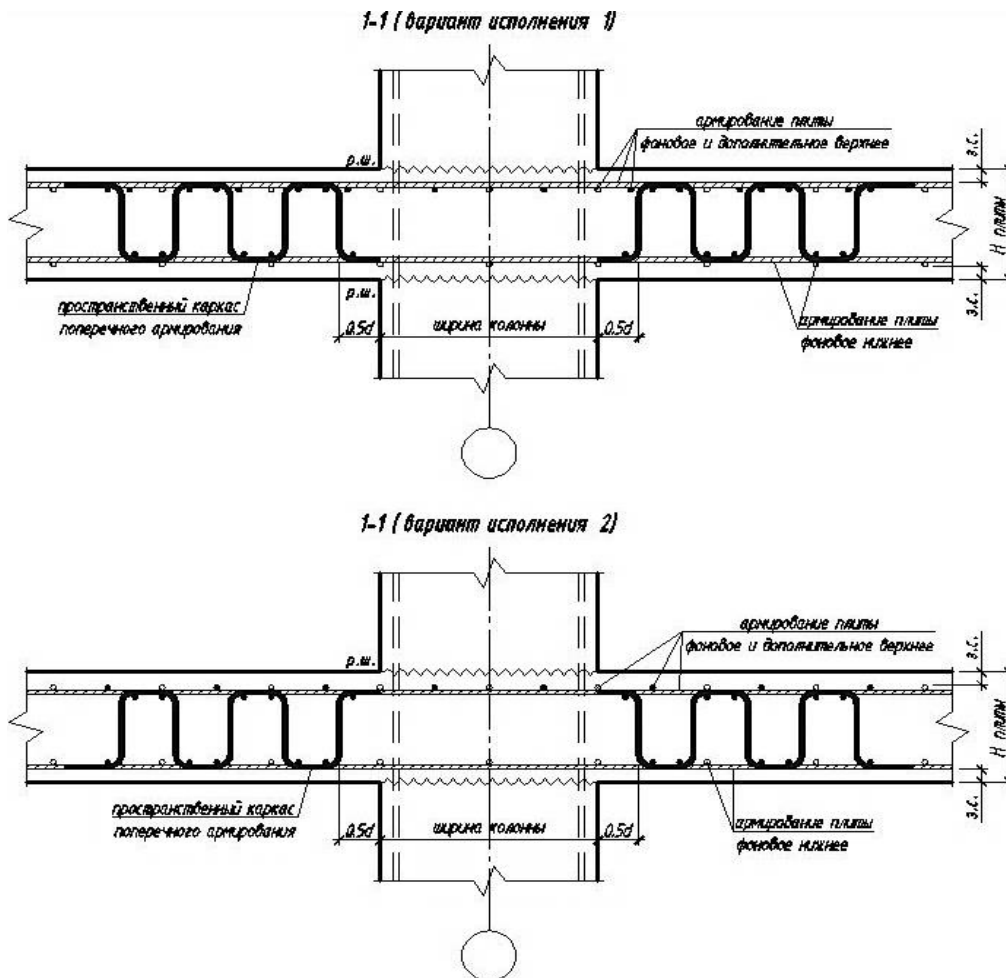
Каркасы поперечного армирования в зоне сопряжения плиты и колонны
